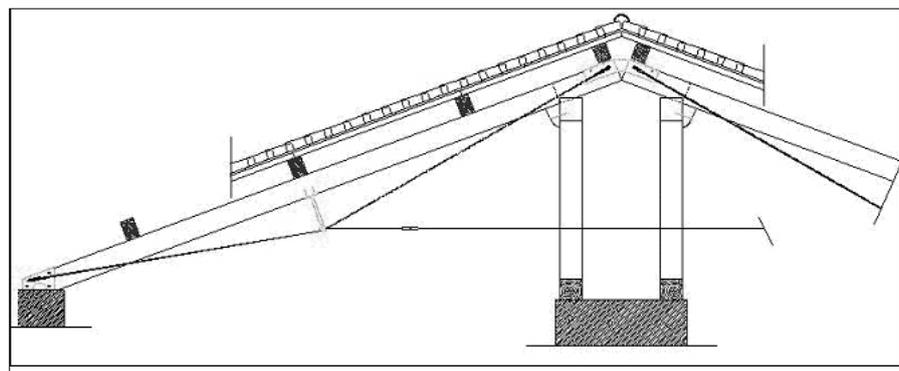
Pavia: castello visconteo. Torre Sud/Est: Schema indicante il posizionamento dei tiranti e delle aste telescopiche.
